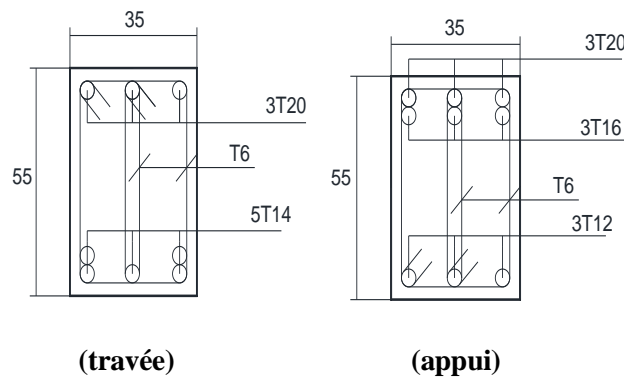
Ferrailage d'une poutre principale 35x55cm (plan avec longues travées)
